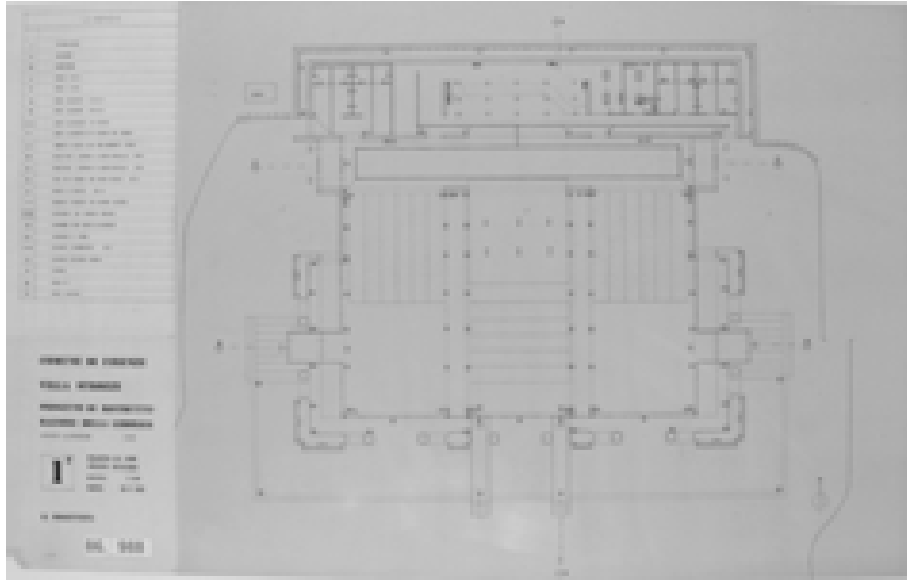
Progetto dell'impianto di illuminazione, 15/07/1985 (AABS-988)
